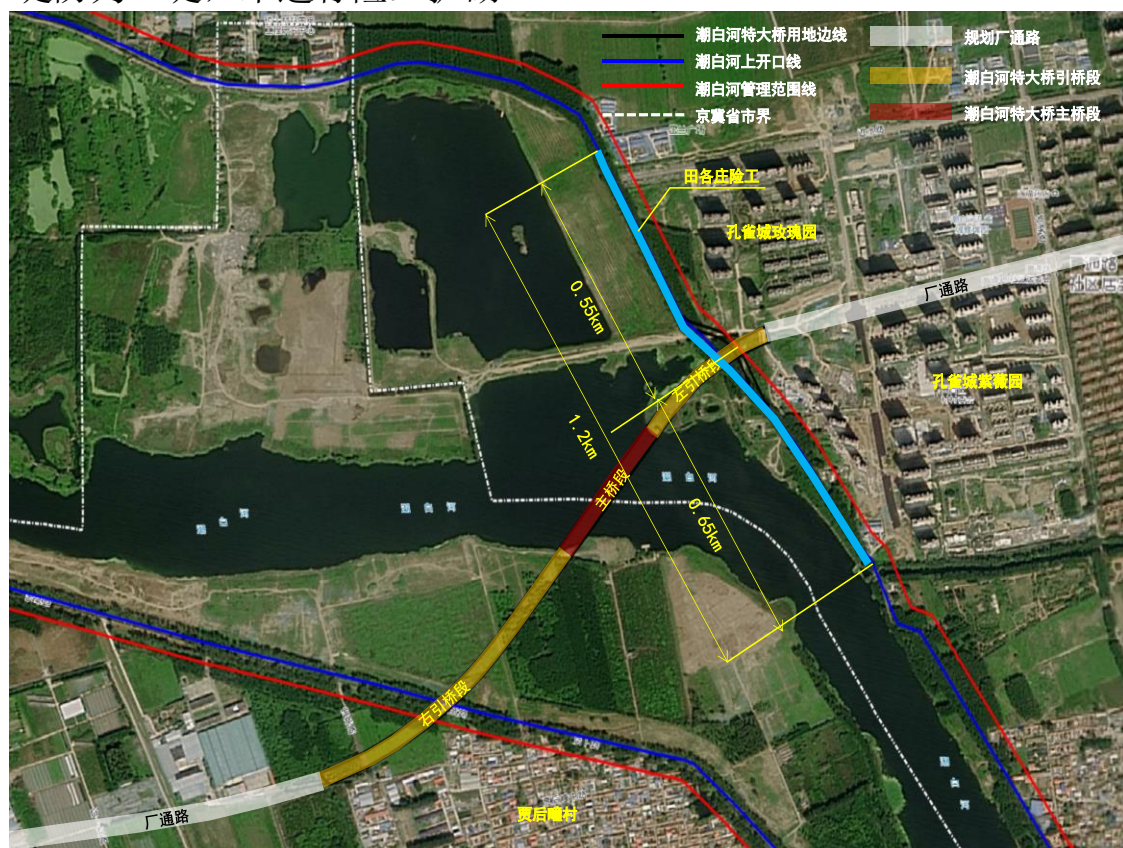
跨河桥梁与田各庄险工位置平面示意图
